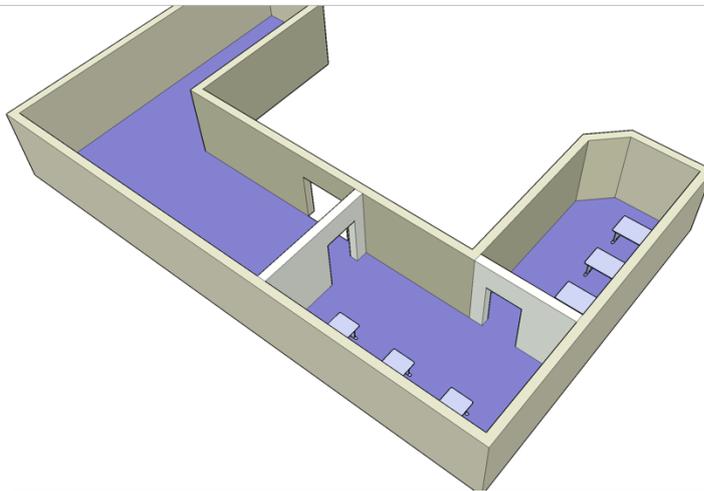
Modelo de la Propuesta en SketchUp de la planta alta del Aula de Informática de Libre Acceso
